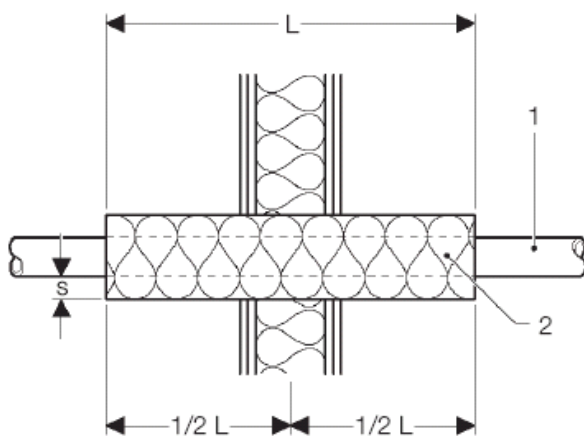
Protection incendie du Geberit PushFit: traversée de mur, mur de construction sèche
